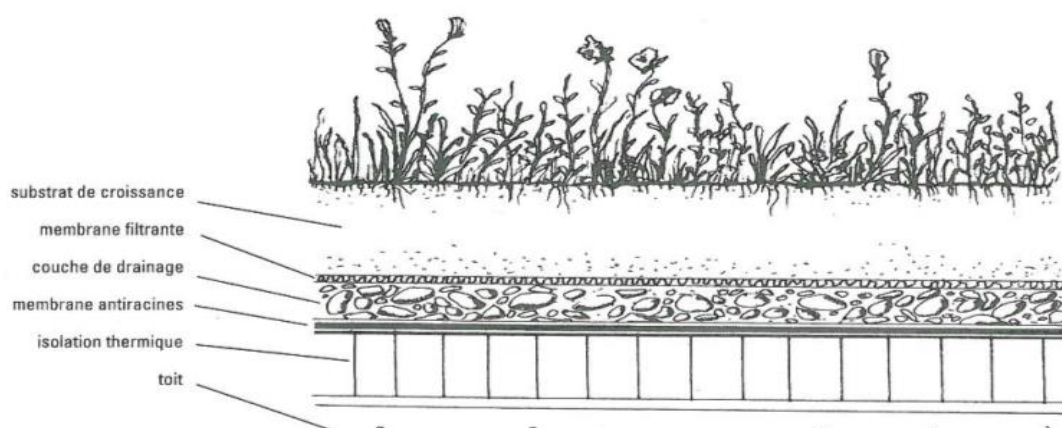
Coupe transversale d'un toit végétal (Source : Toits et murs végétaux de Nigel Dunnnett et Noël Kingsbury, Edition de Rouergue 2008)
